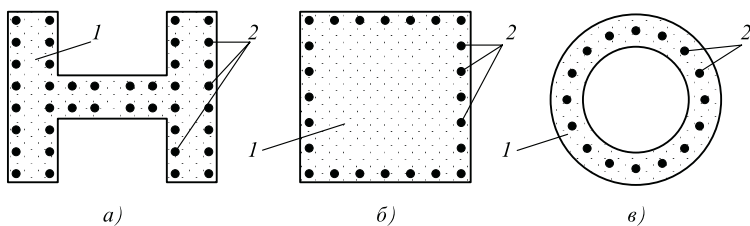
Поперечные сечения стоек железобетонных опор:
